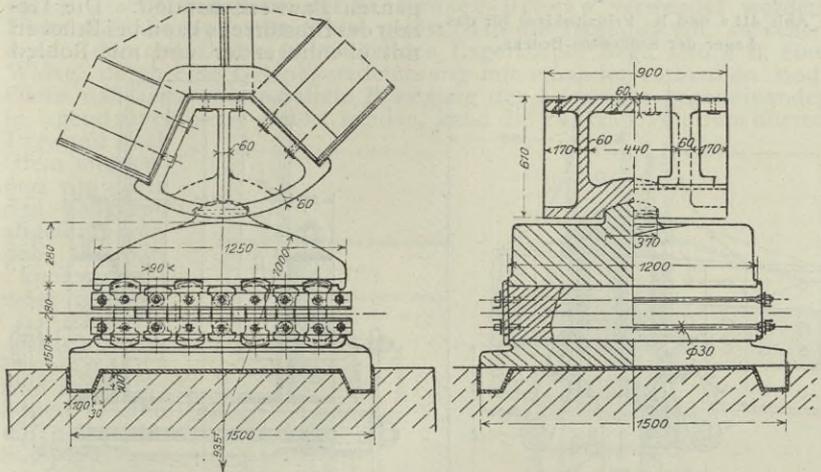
Bewegliches Lager der Brücke über die Havel bei Pichelsdorf.
